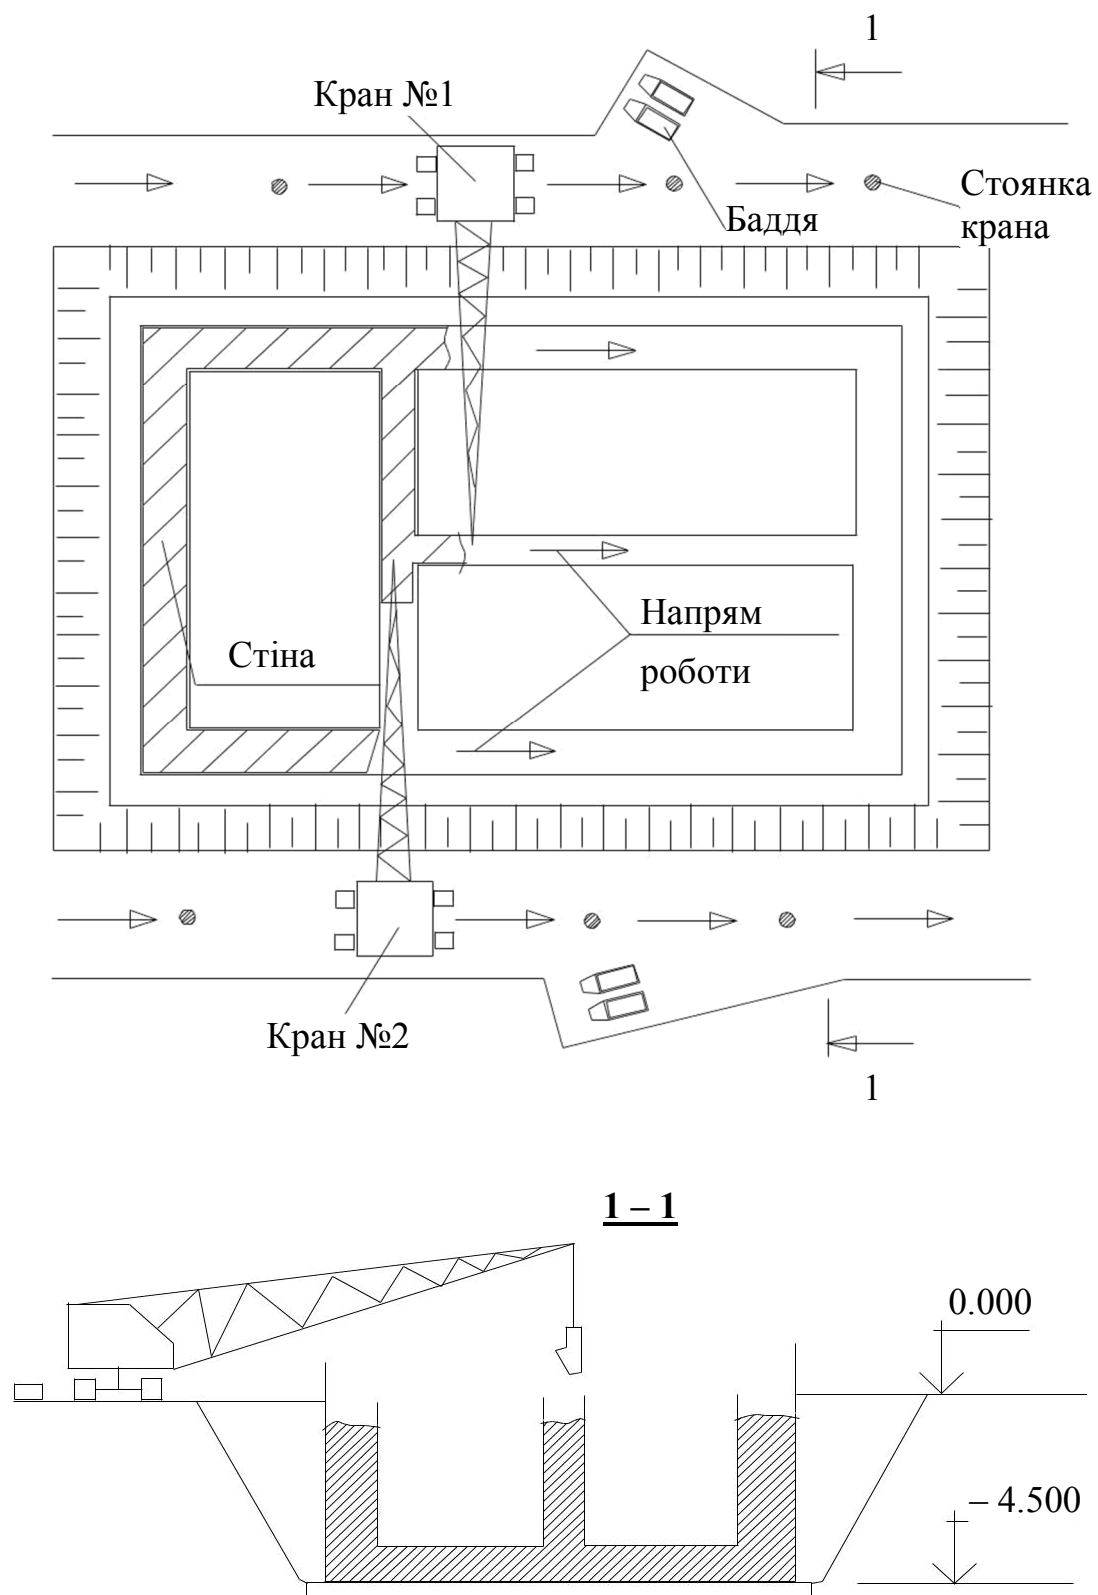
Технологічна схема бетонування стін двома кранами
